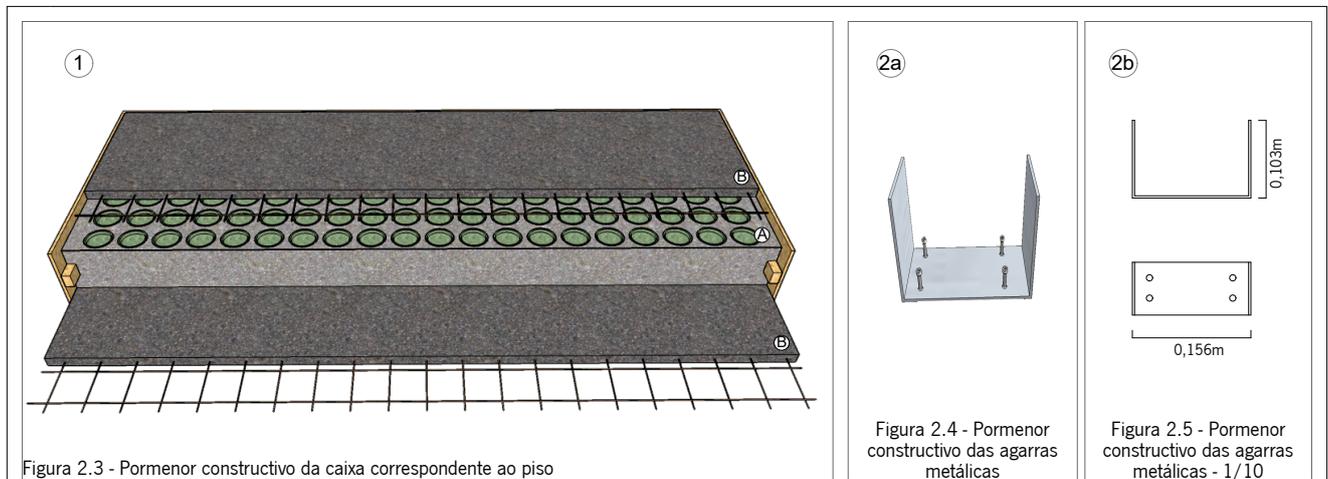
Pormenor constructivo da caixa correspondente ao piso
